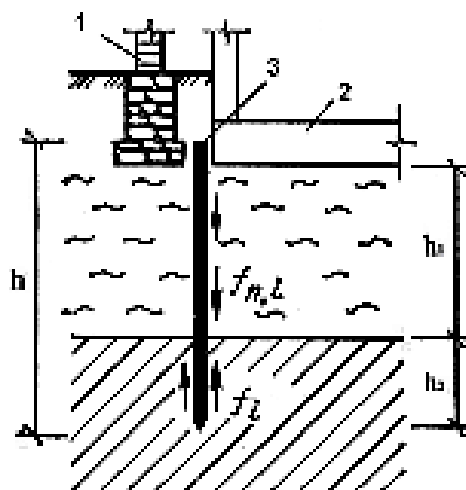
Роз'єднувальна шпунтова стінка: 1 – фундамент існуючої будівлі; 2 – фундамент споруджуваної будівлі; 3 – роз'єднувальний шпунт
